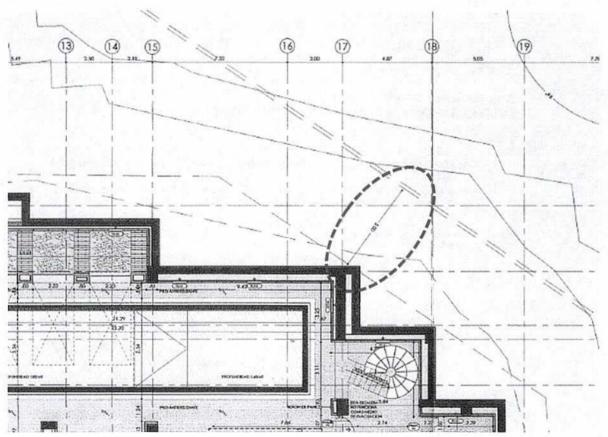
, Licencia MLC 13-3-0448 del 20/06/2016
